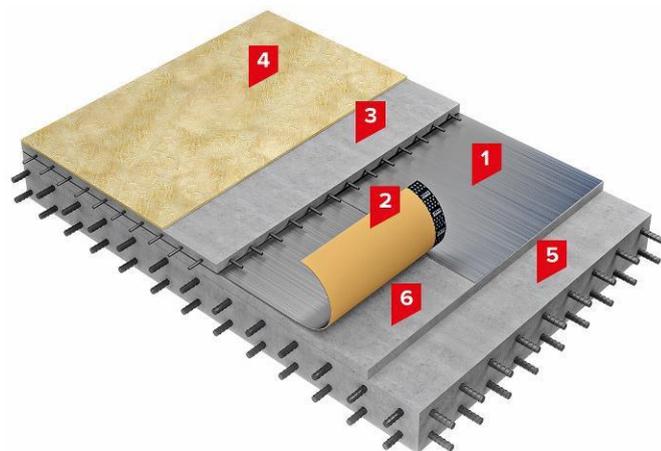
Конструктивное решение цокольного перекрытия над эксплуатируемым подвалом:
